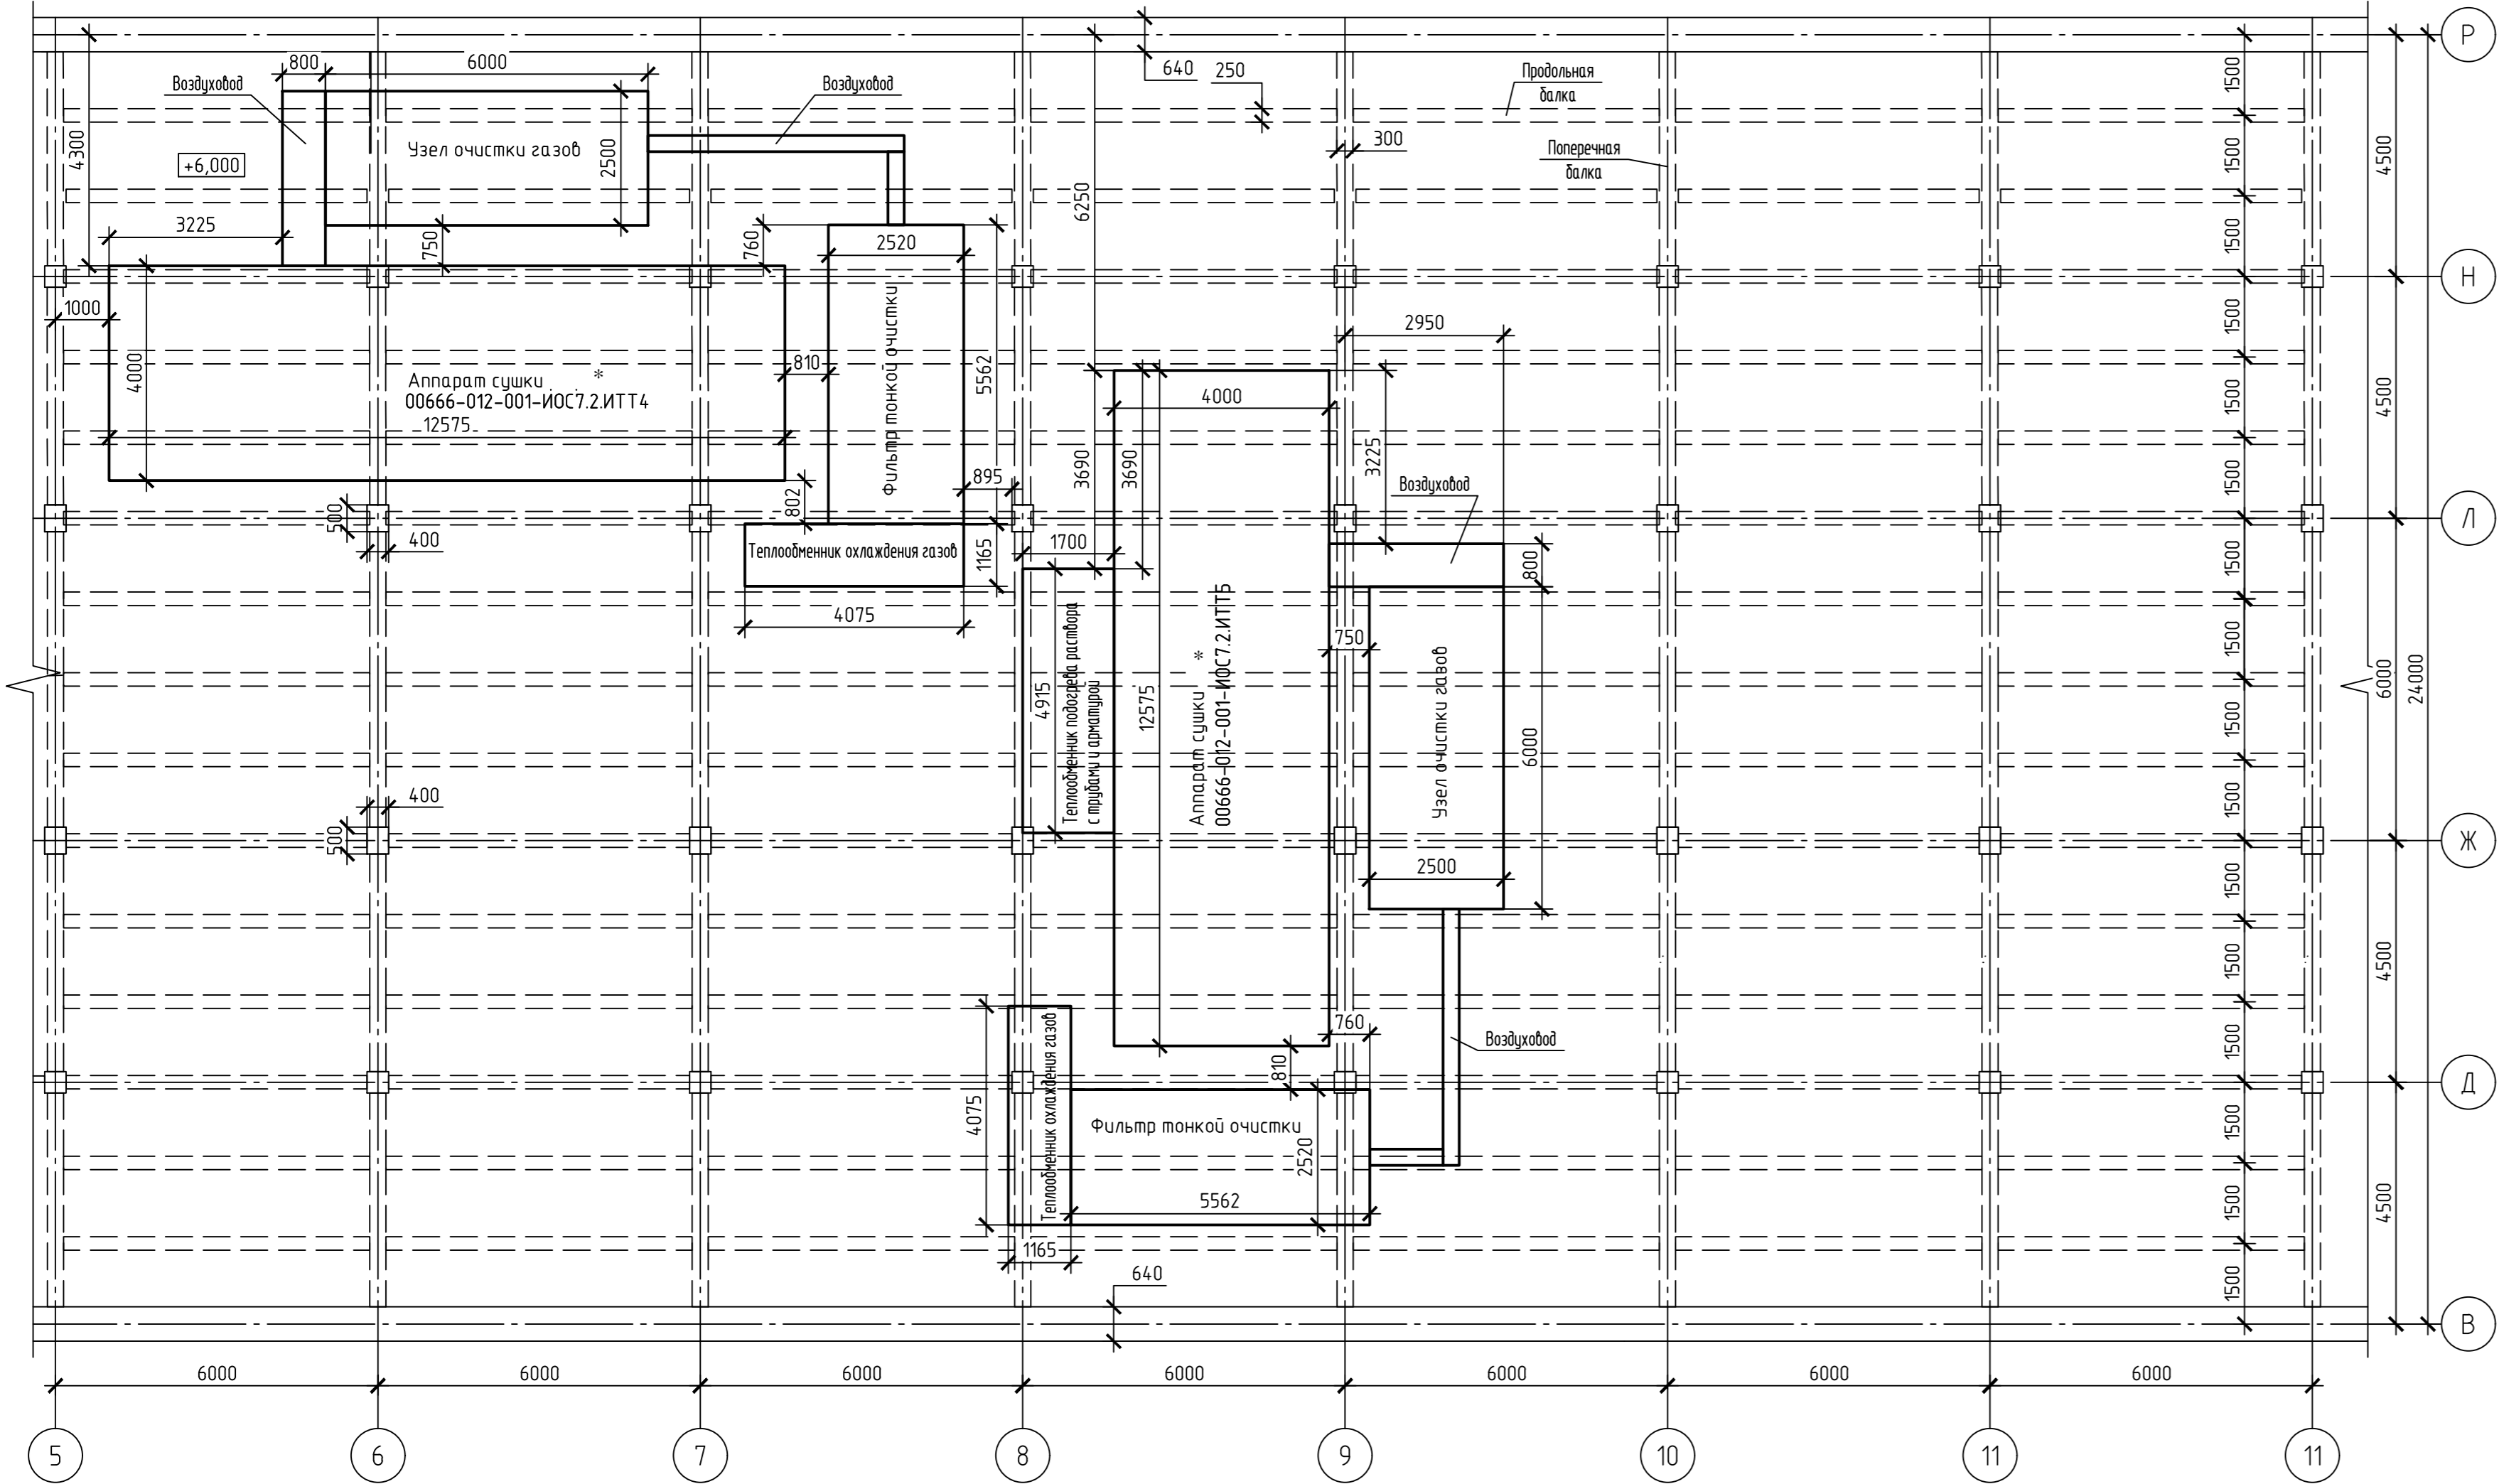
Габаритные размеры установки сушки и прокали
